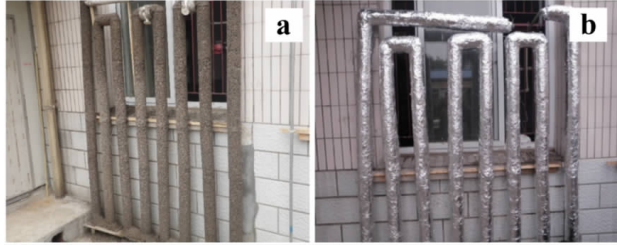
管道保温层水泥基保温砂浆的施工(a. 保温层的施工;b. 防水层的施工)
